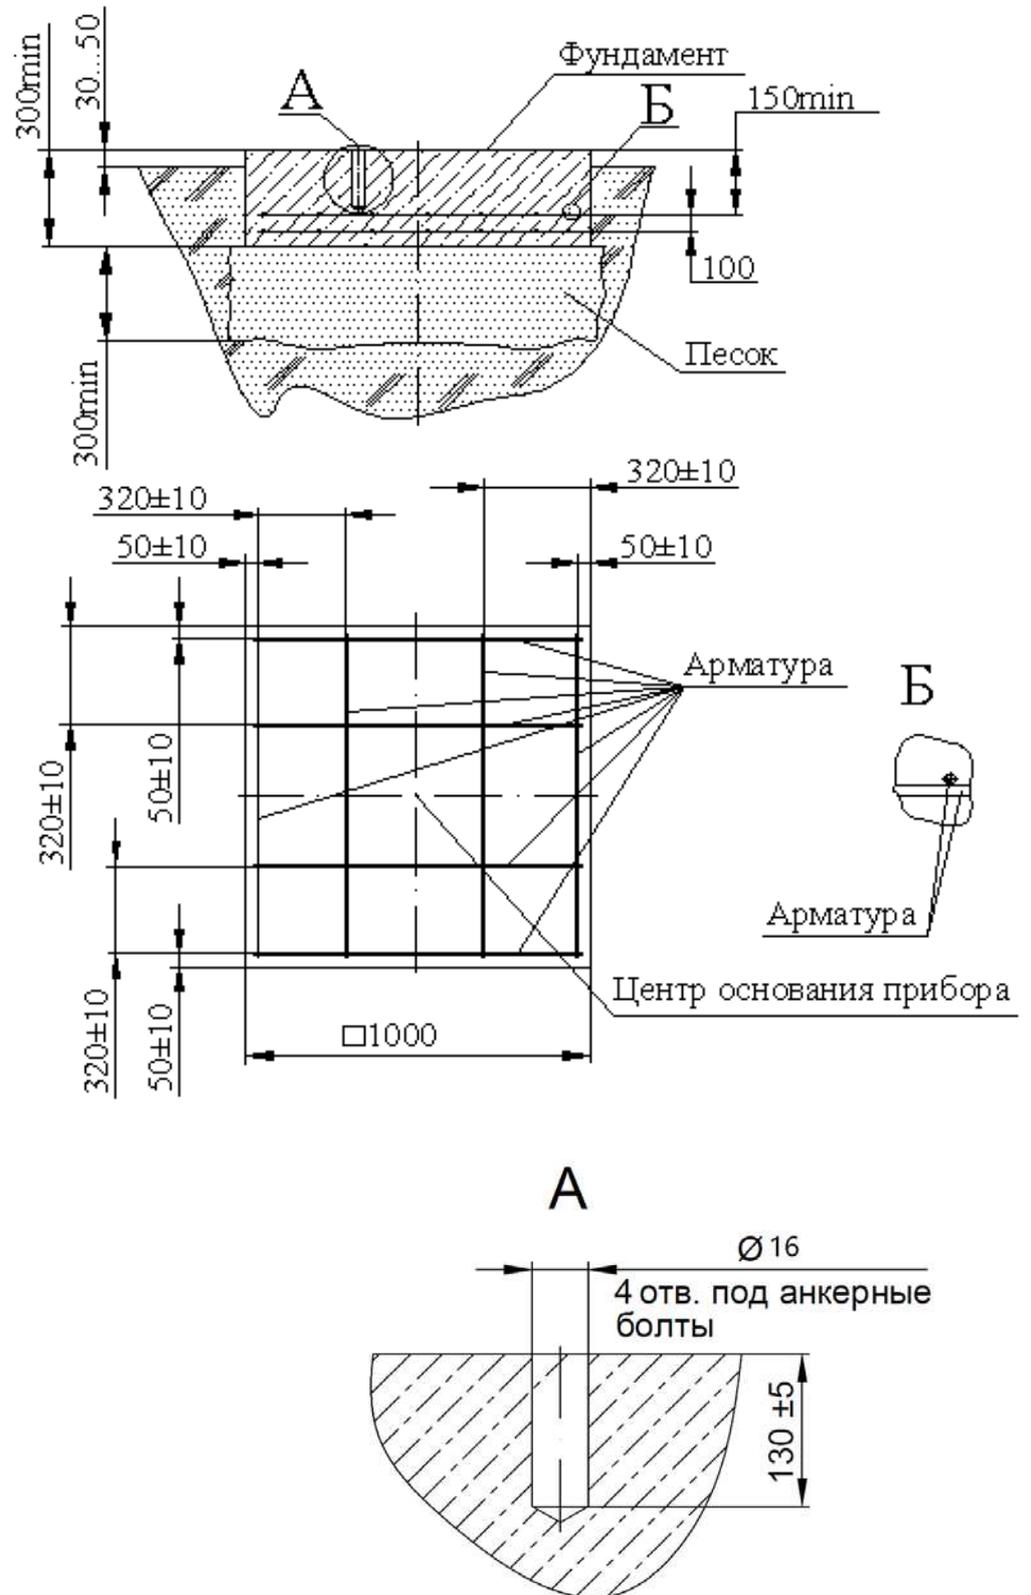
Рекомендуемый вид фундамента для установки прибора на устойчивых грунтах
